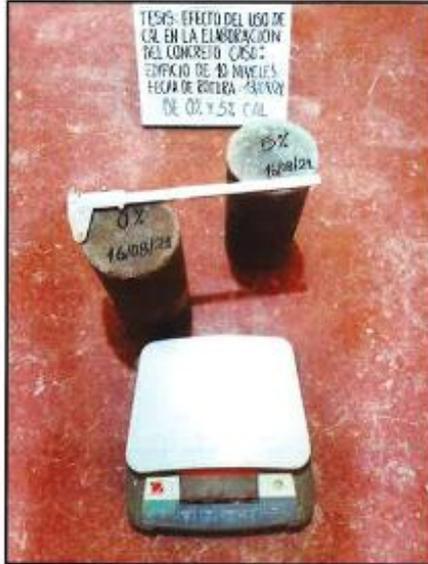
Vista de las probetas de concreto de 0 y 5% de cal.
